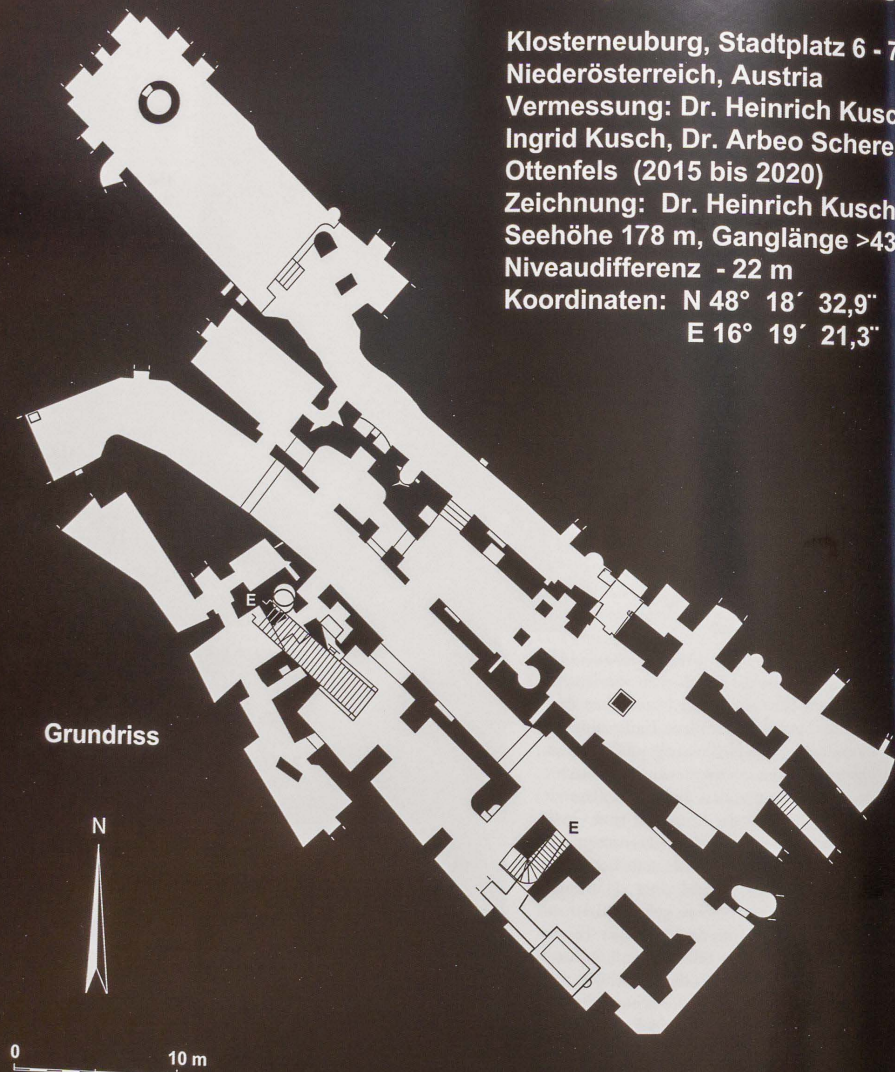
Grundrissplan der „12 Apostel Zeche“.
